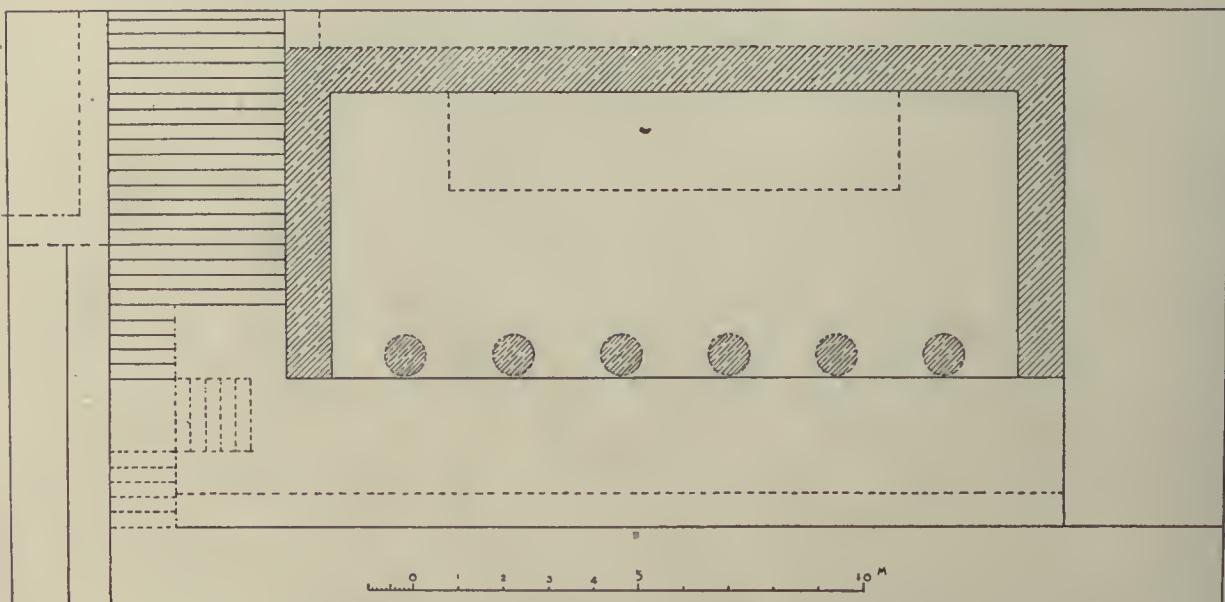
Ex-voto de Kratéros, plan restauré.
